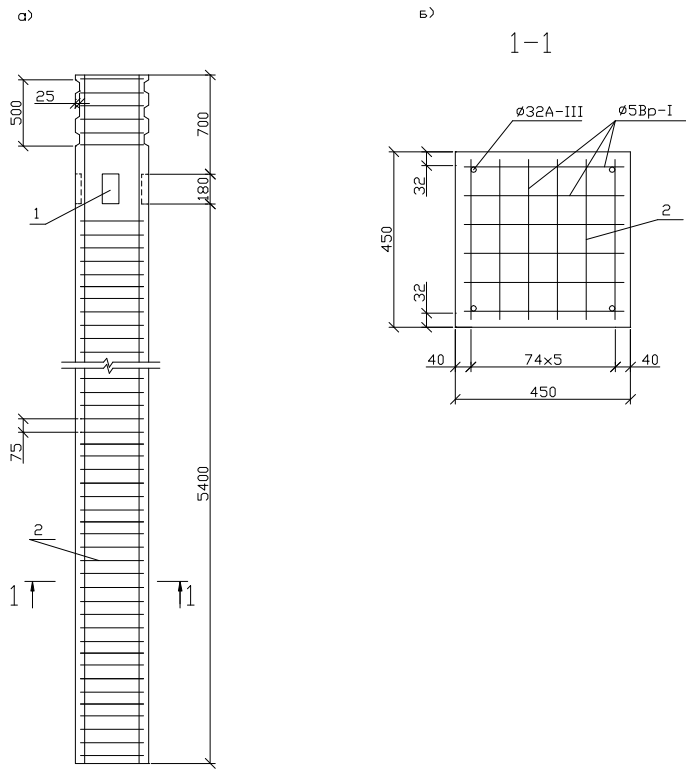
Схема армування колони з непрямою арматурою:
